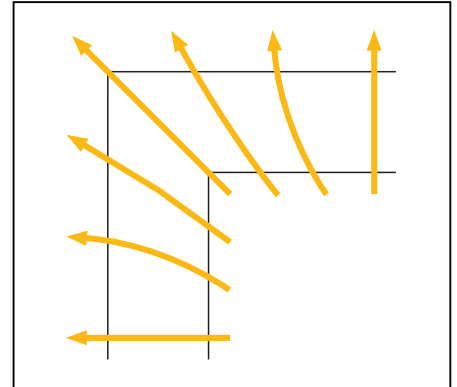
Wärmestromverlauf durch eine zweidimensionale, monolithische Außenwanddecke.
